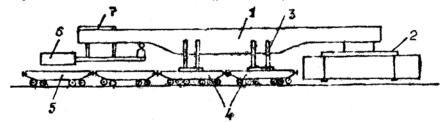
Габаритно-консольный кран ГЭПК-130/17,5 1 — главная ферма; 2 — грузоподъемная траверса; 3 — опорная башня; 4 — восьмиосная платформа; 5 — четырехосная платформа; 6 — подвесной противовес; 7 — откатной противовес
